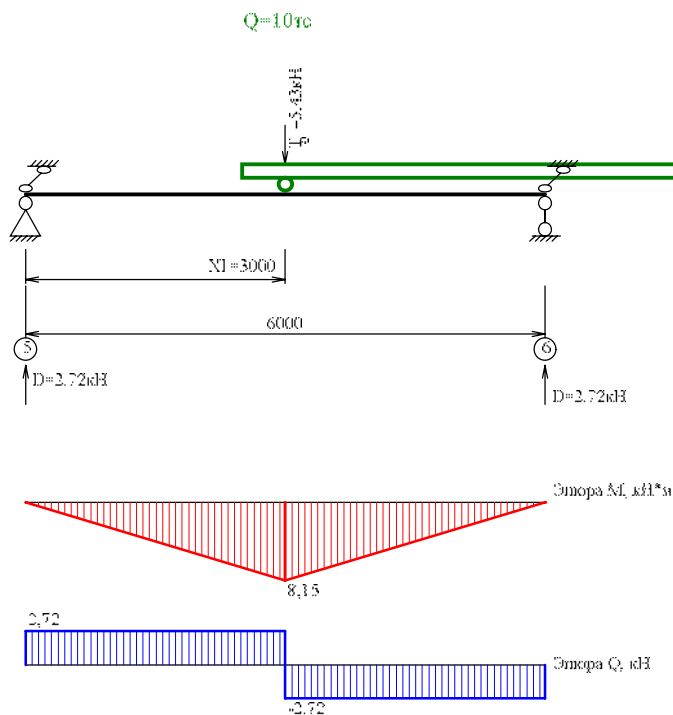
Эпюры усилий M и Q от горизонтальной нагрузки при расчётном положении крана
